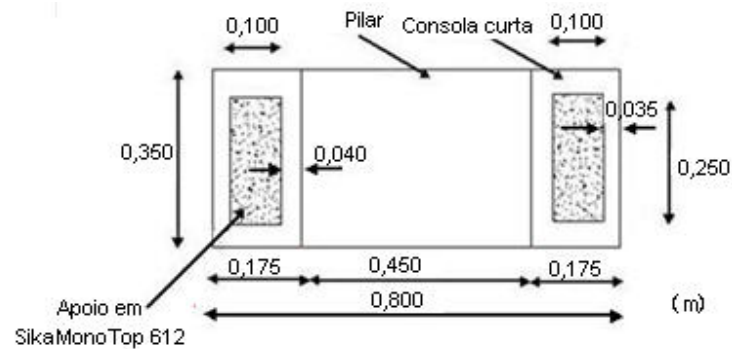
Planta da zona do pilar e da consola curta na direcção X
